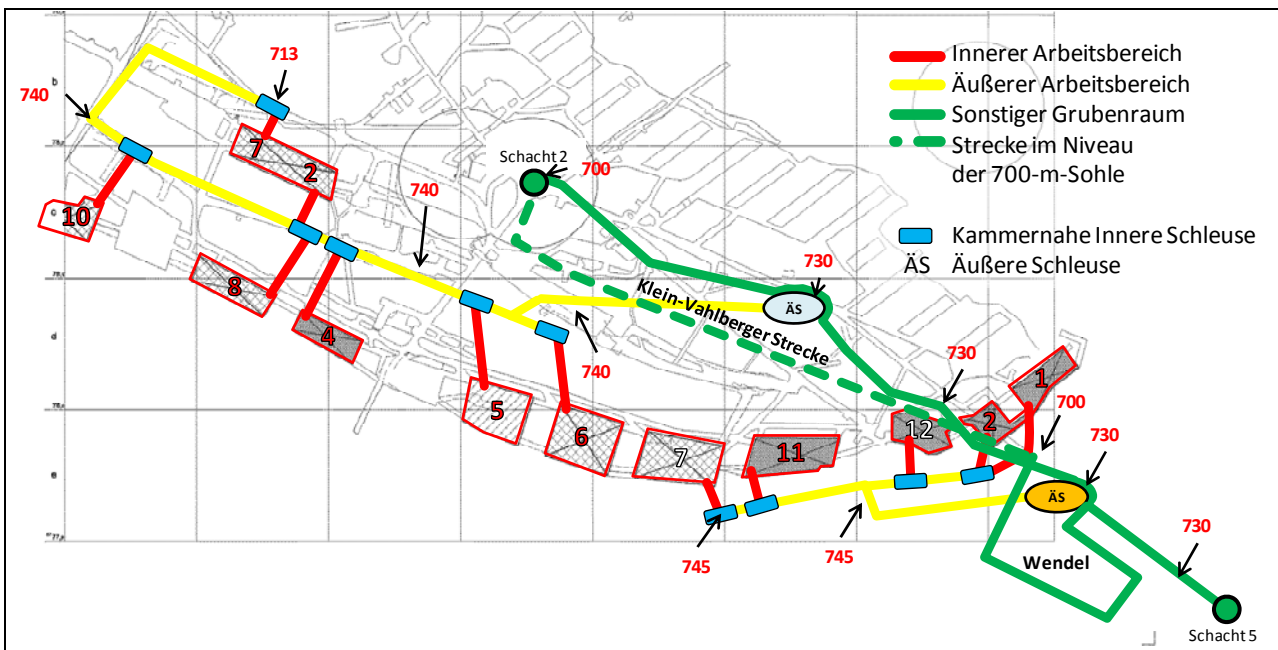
Schematische Darstellung der Mischvariante mit kammernahen Inneren Schleusen an beispielhaften Orten (Hintergrund: Grundriss der 750-m-Sohle).
